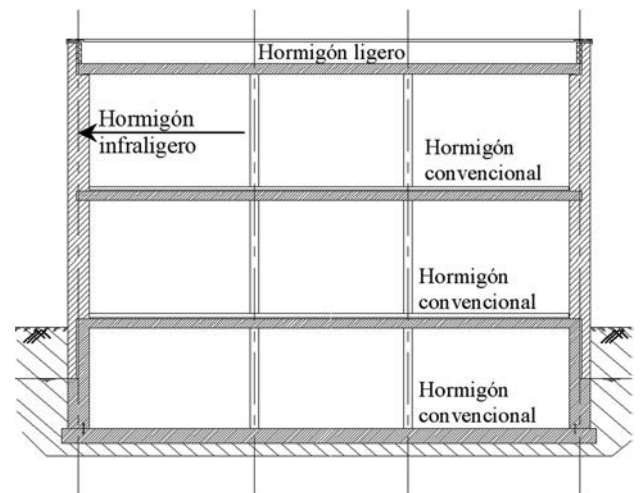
Prototipo de vivienda con hormigón visto con muros de hormigón infraligero.
